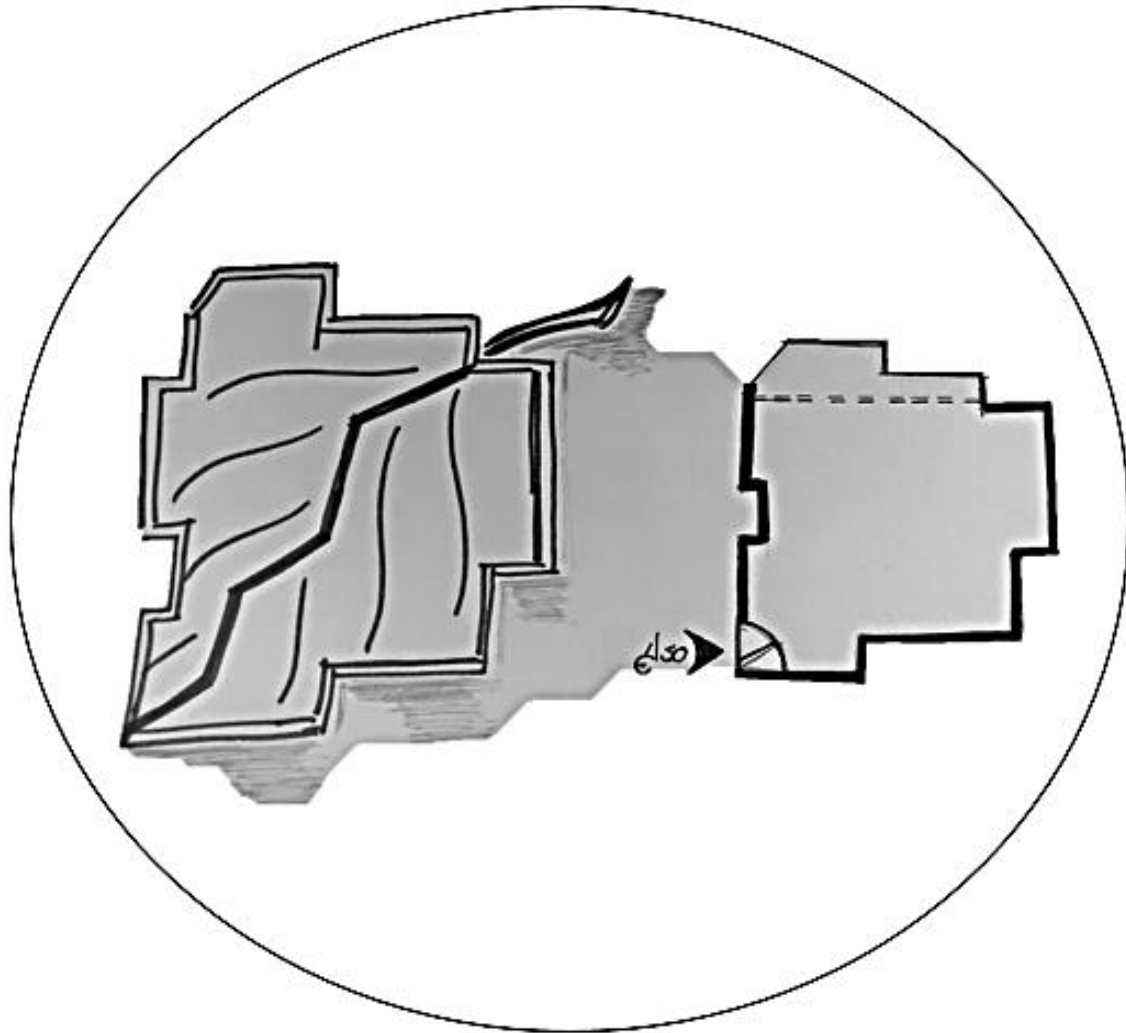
Boceto de concepto y primera idea de planta arquitectónica. Fuente: Elaboración en taller de tesis 2021.
